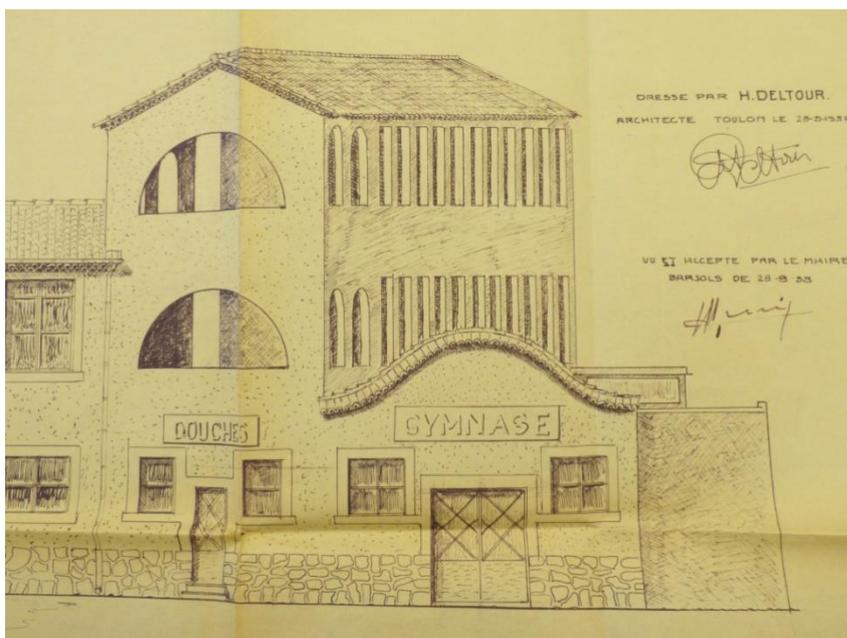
Construction d'une école de filles, façade place de la Rouguière, détail, Henri Deltour (architecte).
